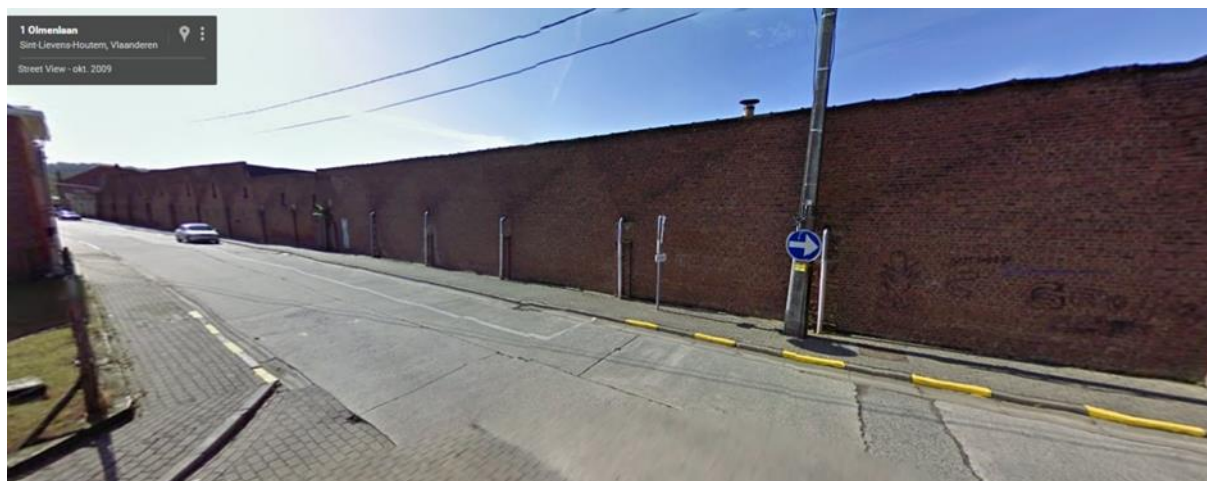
Foto van de bestaande situatie. Zicht naar het westen vanuit het oosten (Google Streetview, 15-11-2018).
